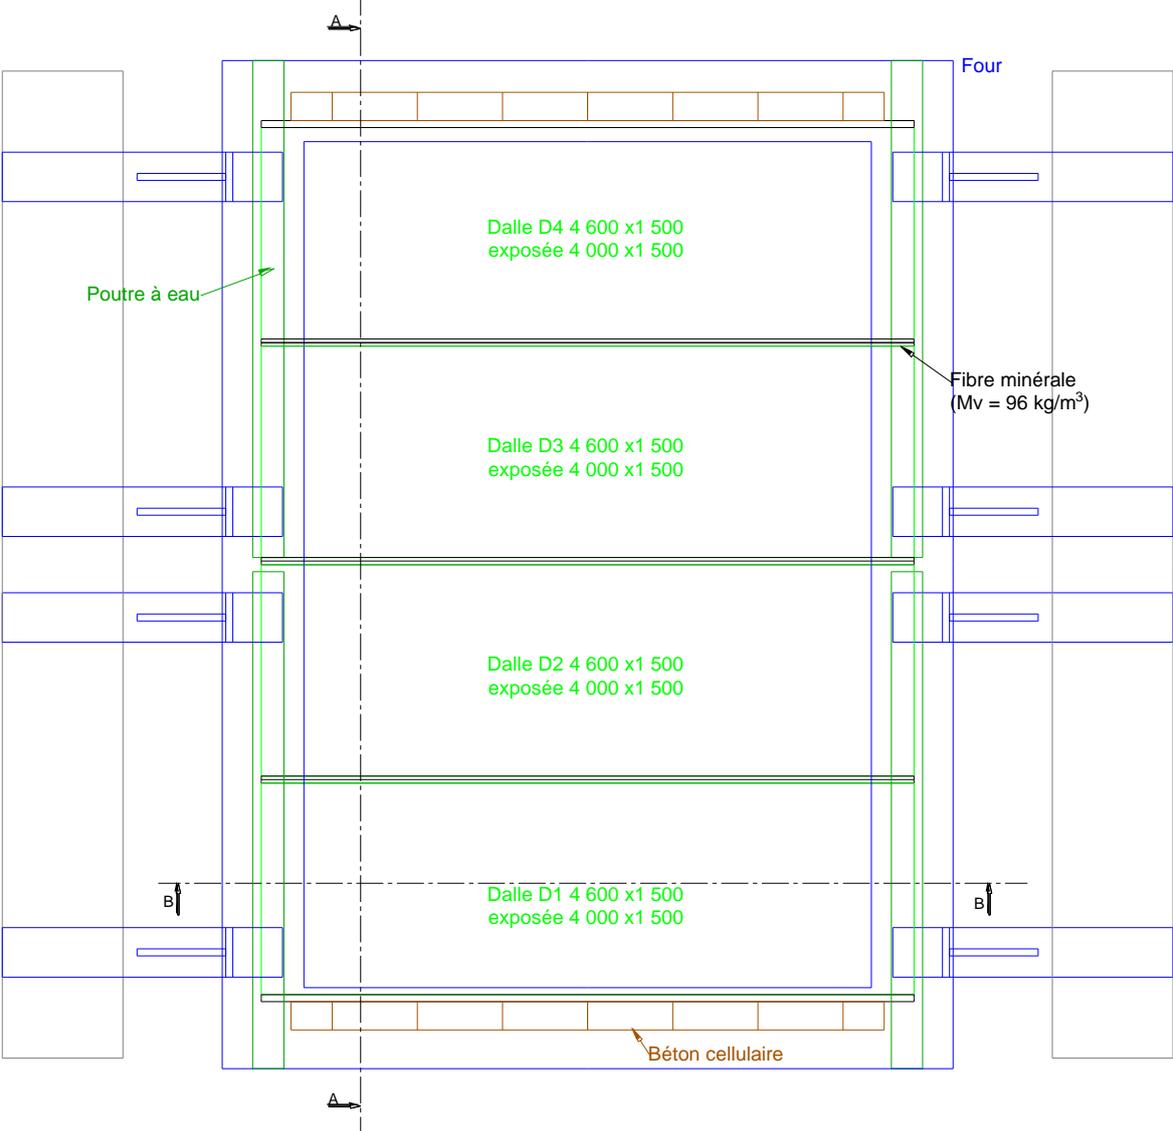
Configuration d'essai pour les 4 dalles horizontales
